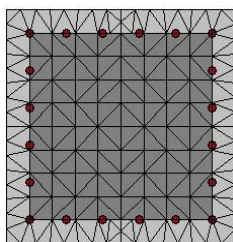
Discrétisation en fibres d'une section de poteau
